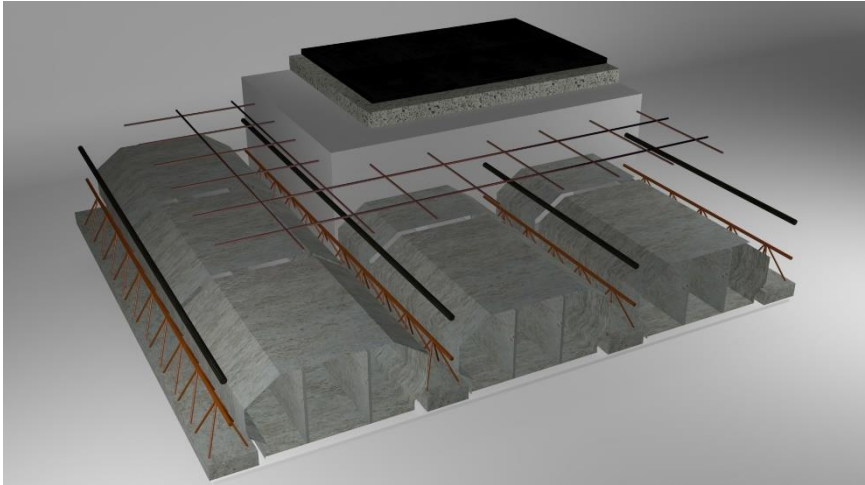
3D Forjado viguetas prefabricadas. 2015. Fuente propia.
